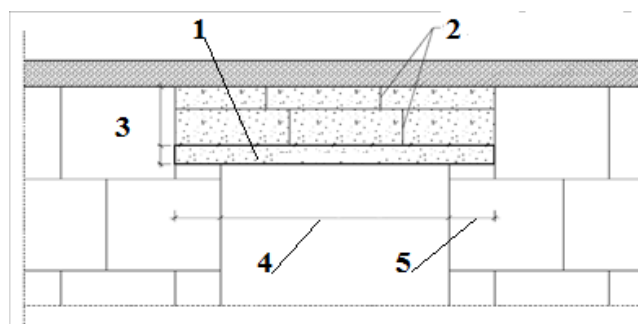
Конструкция перемычки: 1 — перемычка; 2 — вертикальные швы, заполненные раствором; 3 — перекрытие перемычки; 4 — пролет в свету; 5 — глубина опирания
